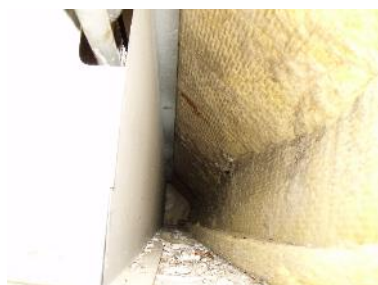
Zone située entre les radiateurs et le mur extérieur
